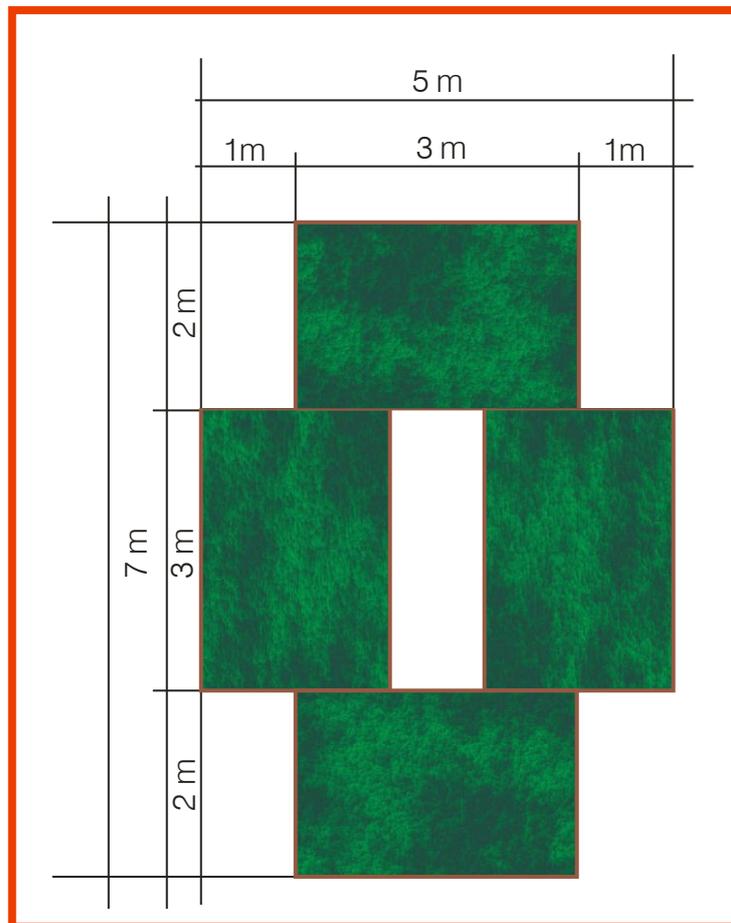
Schema planimetrico dell'associazione di isole galleggianti
